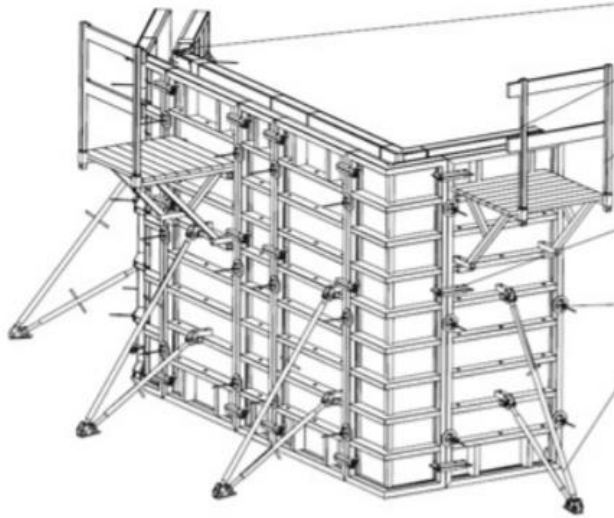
Фрагмент великощитової опалубки для бетонування стін
